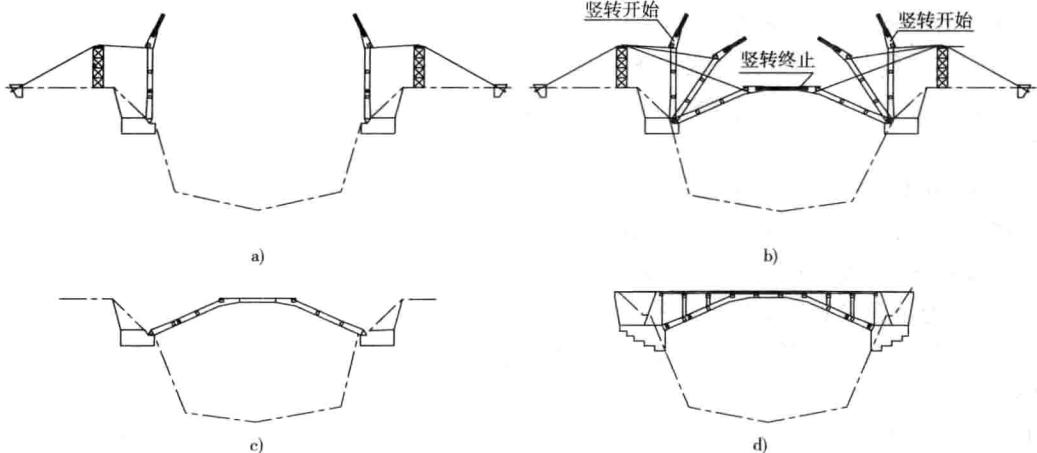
预应力混凝土八字形刚架拱桥主要施工工序
